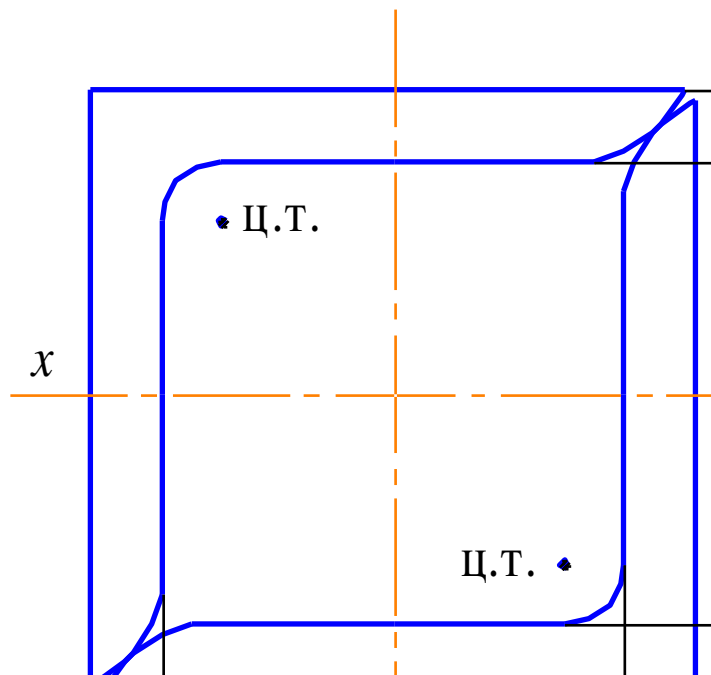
Схема к расчёту сечения коробчатой формы
